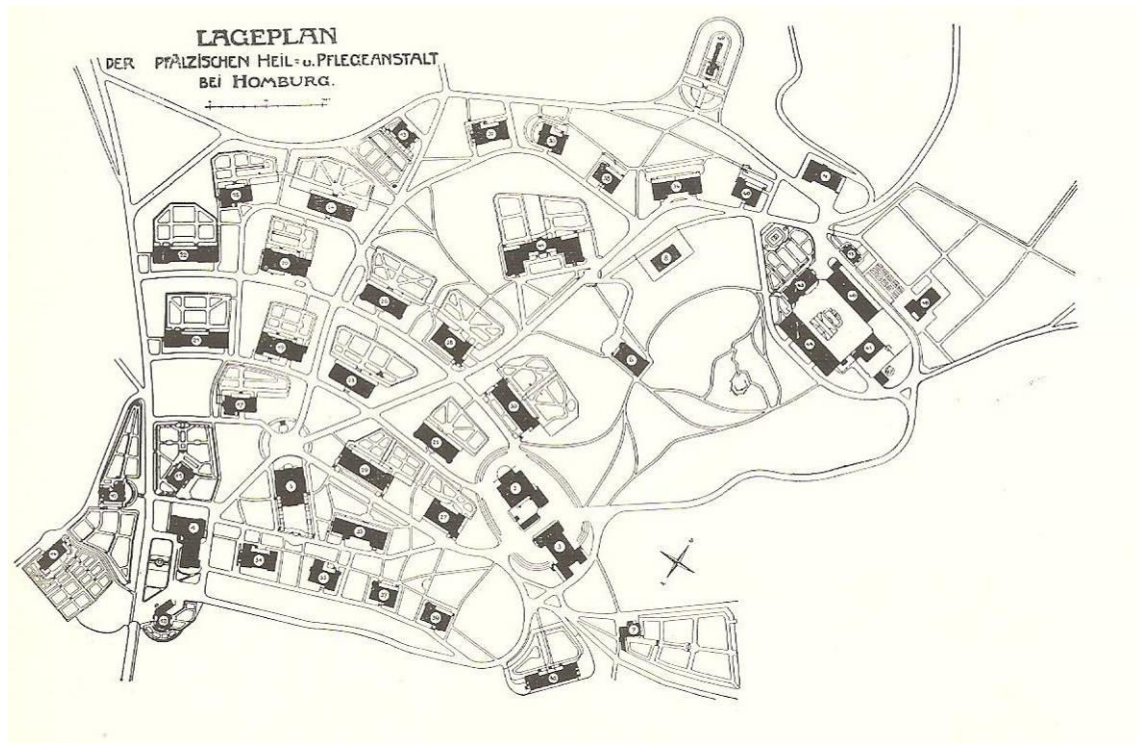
Lageplan der „Heil- und Pflegeanstalt Homburg“, Kgr. Bayern, Kreis Pfalz
